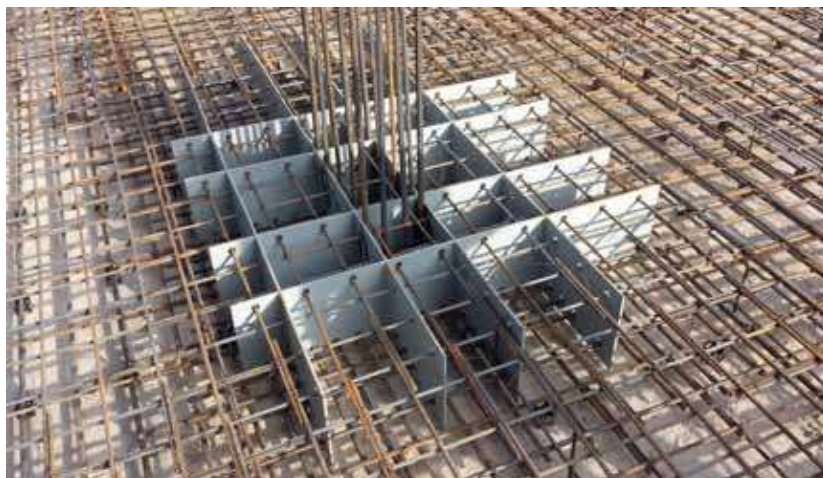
, а. Скрытая металлическая решетка фундаментной плиты
